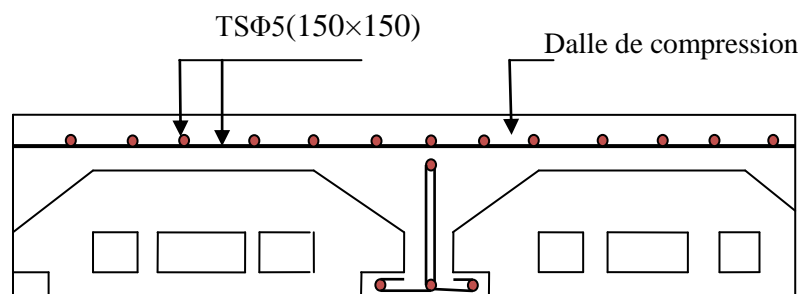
Schéma de ferrailage de la dalle de compression
